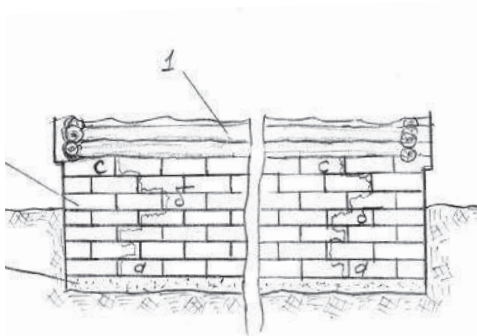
Разрушение фундамента из стеновых блоков: 1 – сруб из кругляка; 2 – фундамент; 3 – песчаная подушка
